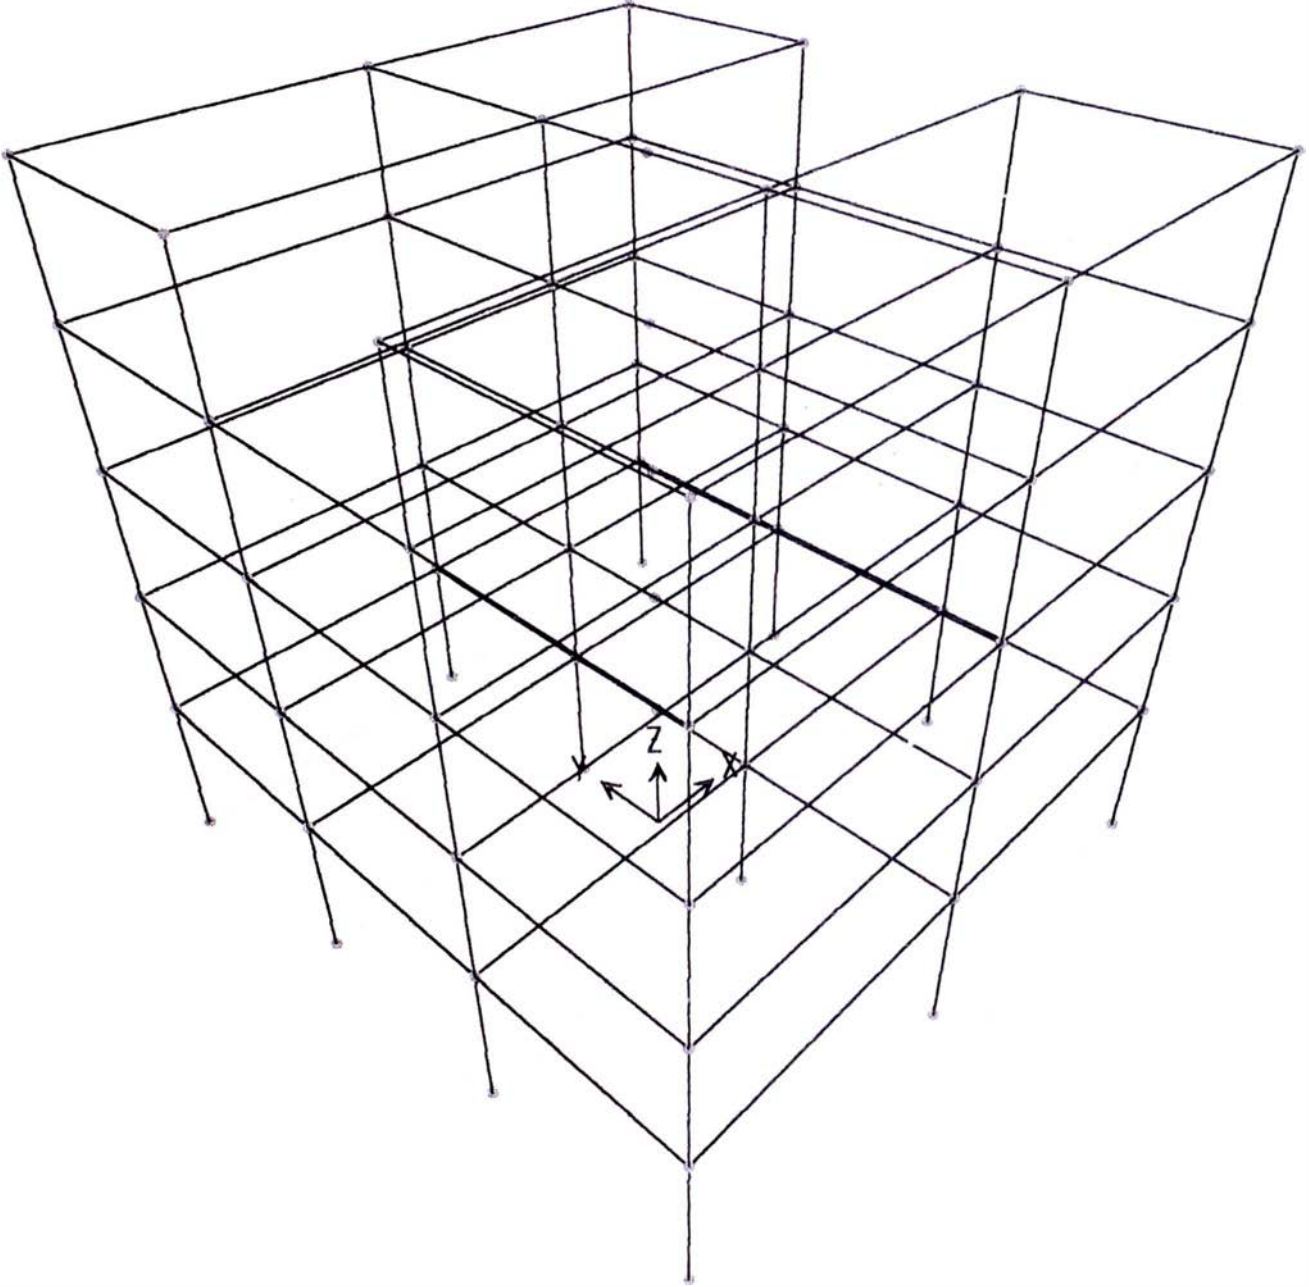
(a). CONFIGURACIÓN ESPACIAL DE LA EDIFICACIÓN.
